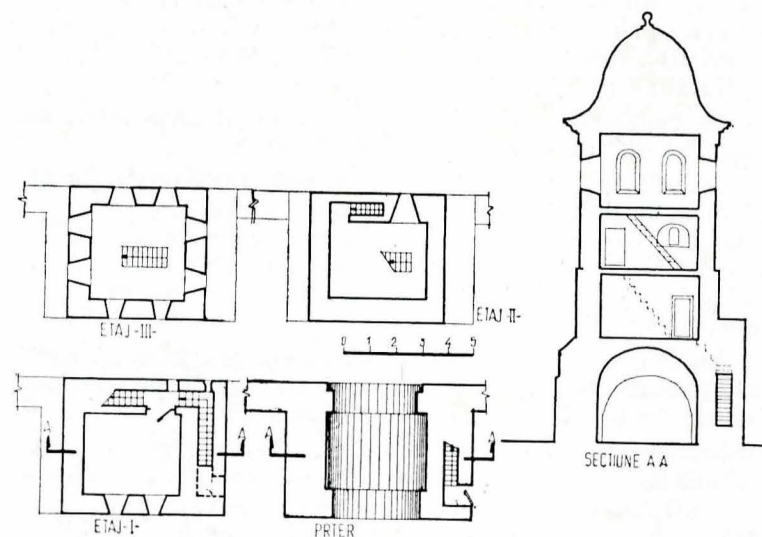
b. Turnul clopotniță din incinta fostei Mănăstiri Apostolache (plan parter, plan etaj I, plan etaj II, plan etaj III și secțiune).
